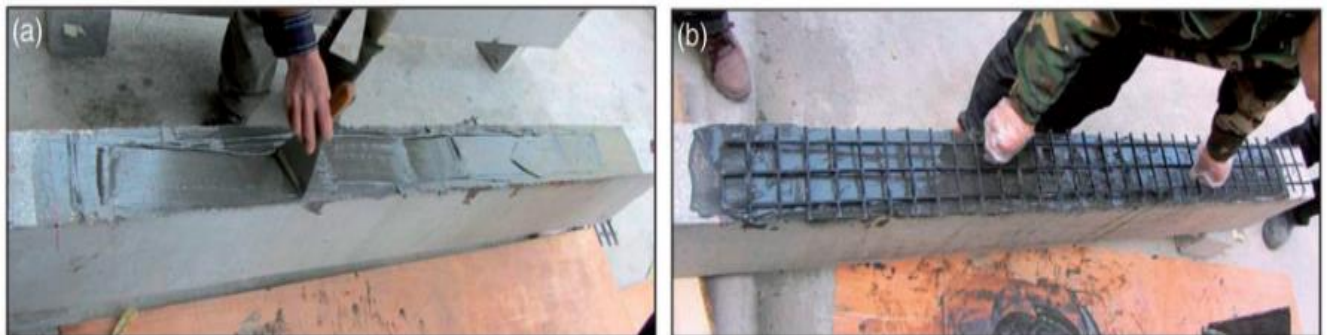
Collage de la grille (BRP grids) sur la poutre [Ali, N. M. et al 2015].
